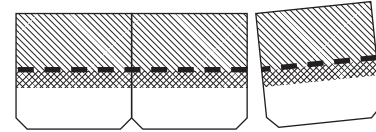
Les bardeaux accessoires Shadow Ridge se détachent facilement de la bande de trois pièces pour former 72 pièces de recouvrement individuelles.
